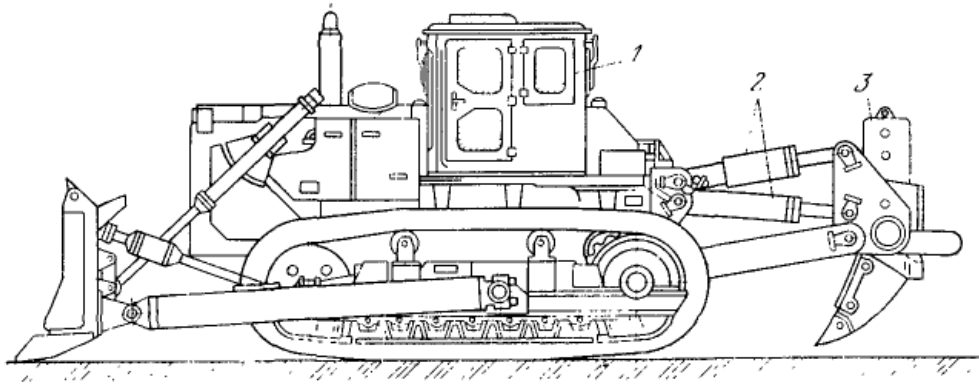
Конструктивна схема навісного розпушувача: 1 – базовий трактор; 2 – гідроциліндри керування; 3 – робочий орган (зуб)
